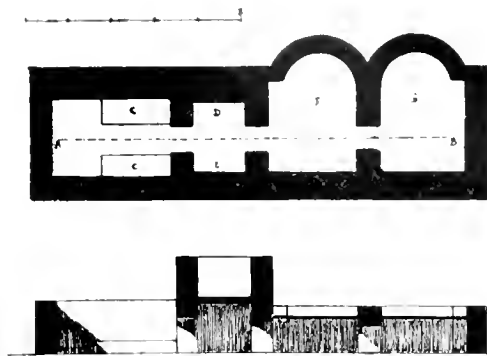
Foru de Tarragona, planta y secció (Hernández Sanalucía)
